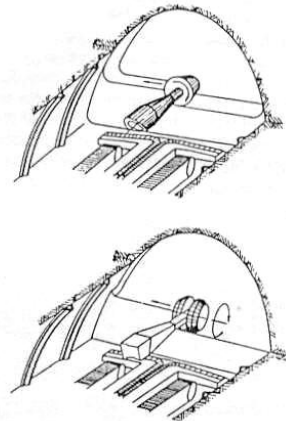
Perfiles de excavación de ambos tipos de cabeza de corte
